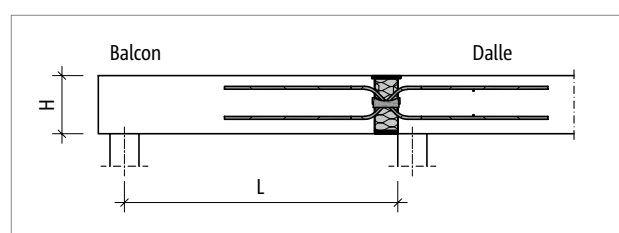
Schöck Isokorb® T Type Q-E-VV : Système statique
